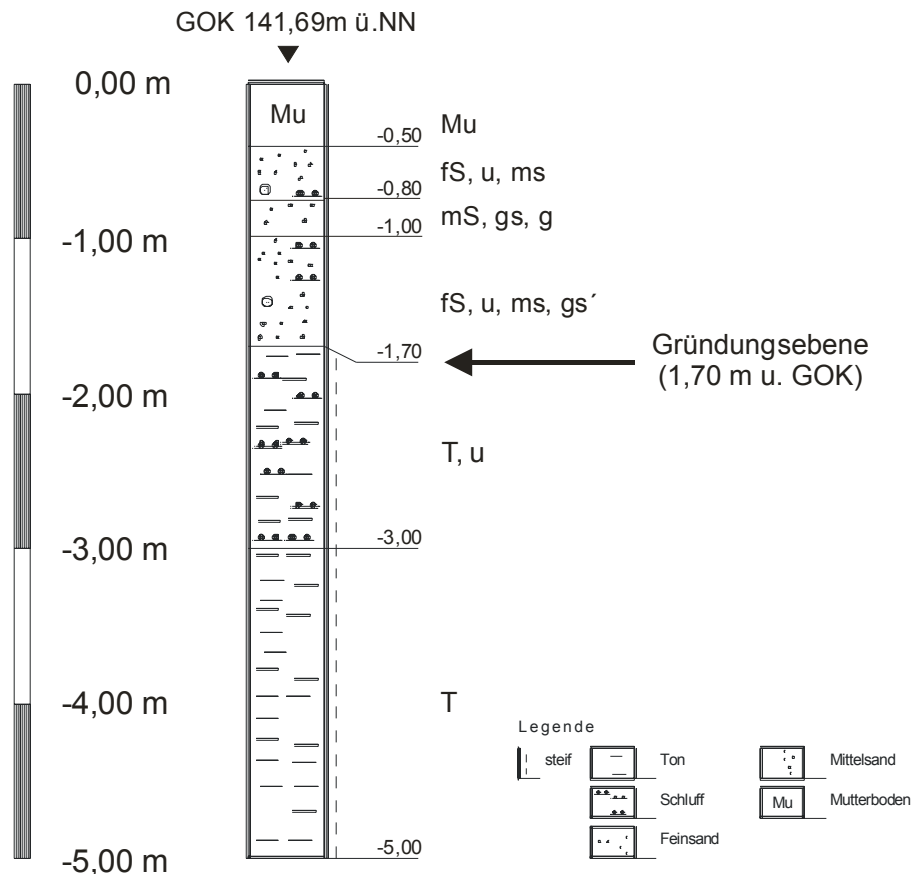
Bodenaufbau im Bereich des Kirchengeländes in Gilzum
